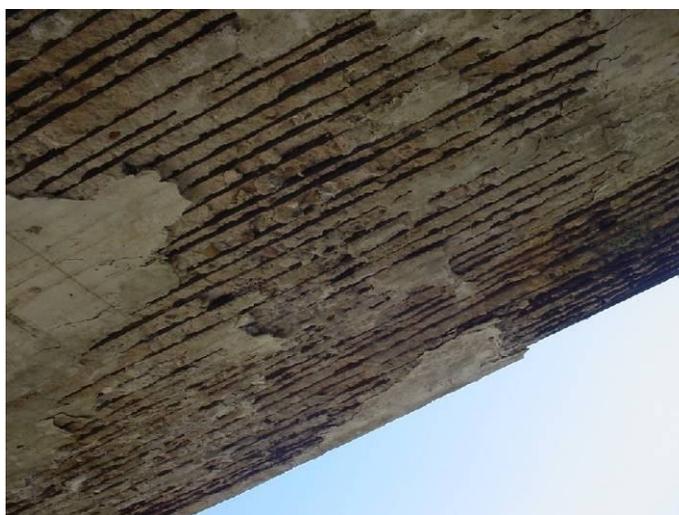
Vista inferior das lajes do tabuleiro, mostrando deslocamento do concreto e corrosão das armaduras. (Fonte: VITÓRIO, 2008).
